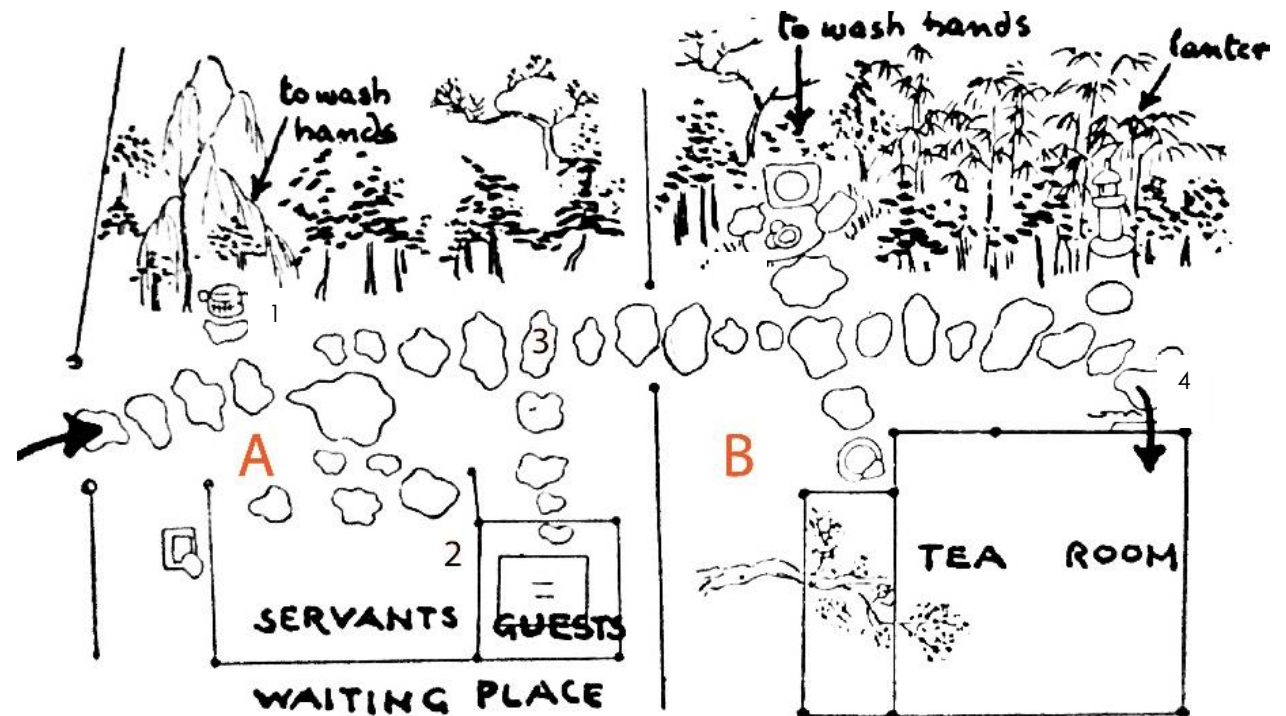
plano japonés, Casa de té - Fuente: (Taut, 2007, p. 173)
